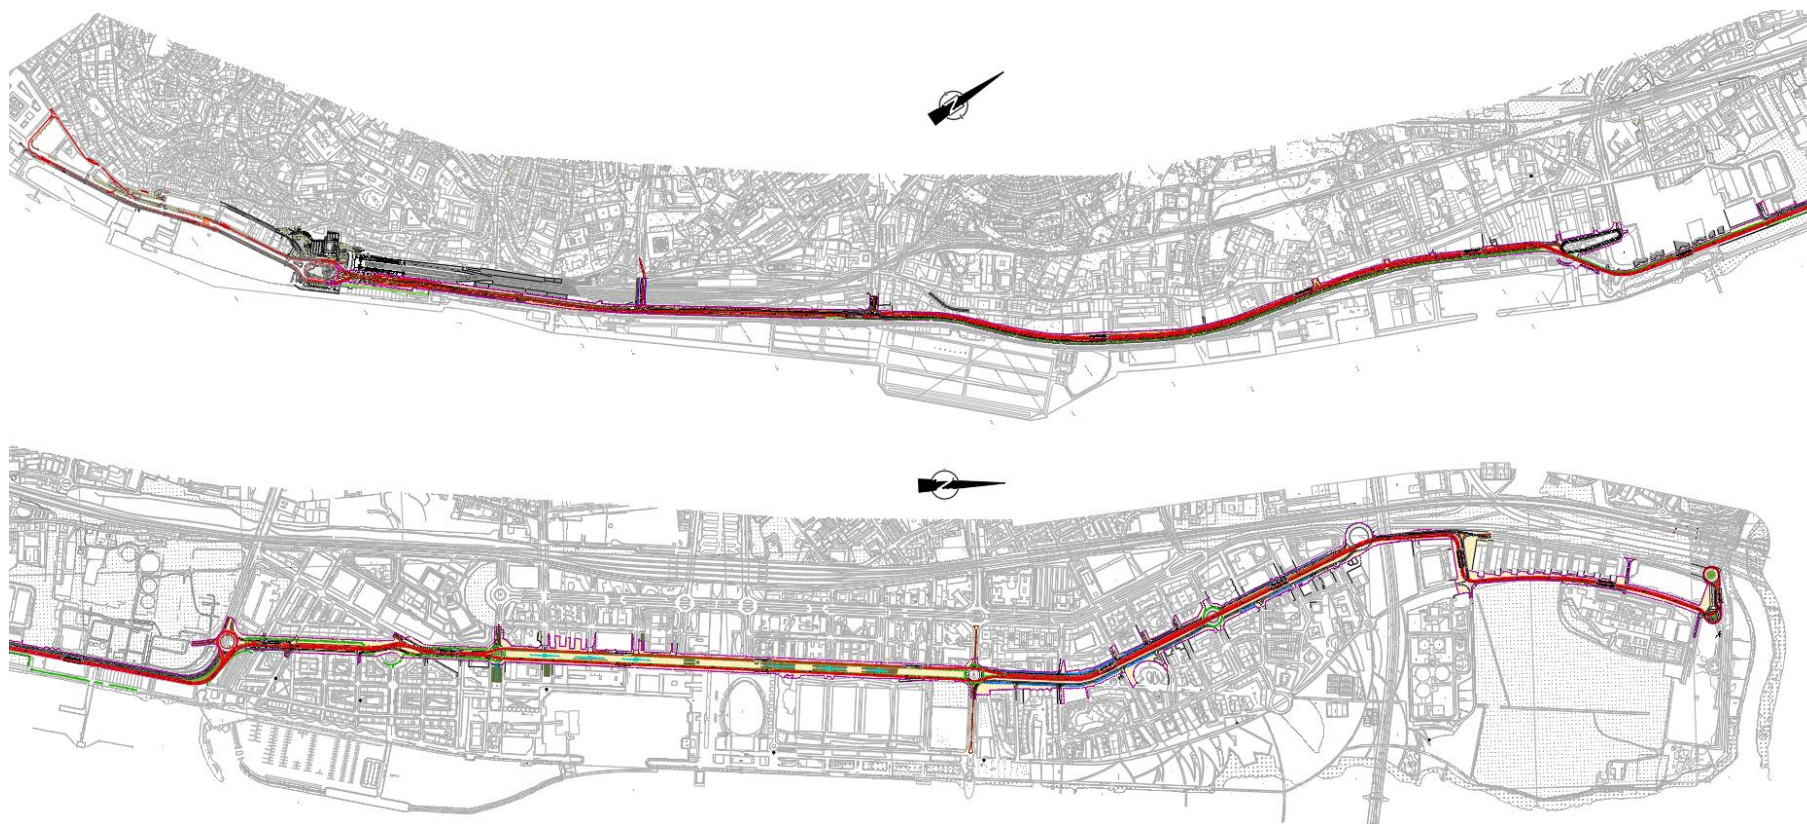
Desenvolvimento da Alternativa 1 (em planta)
